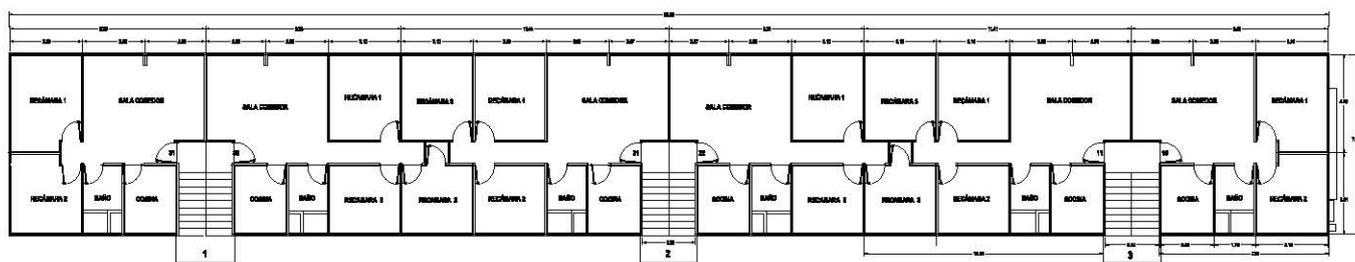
Planta de los edificios 4-A, 4-B y 4-C
